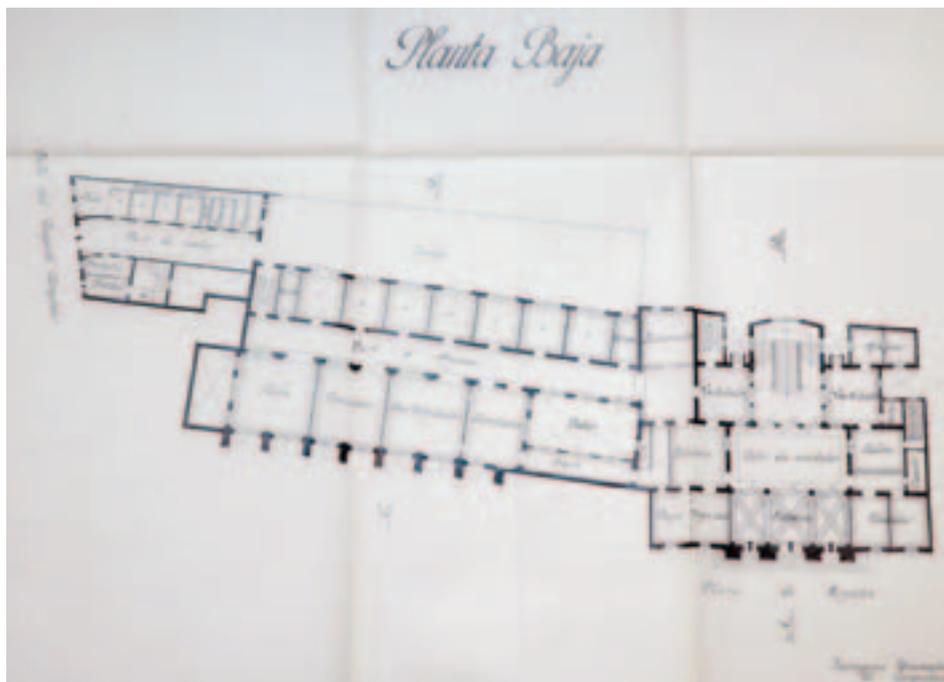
Planta baja del anteproyecto de 1942 de Teodoro Ríos Balaguer (A.D.P.Z.).
